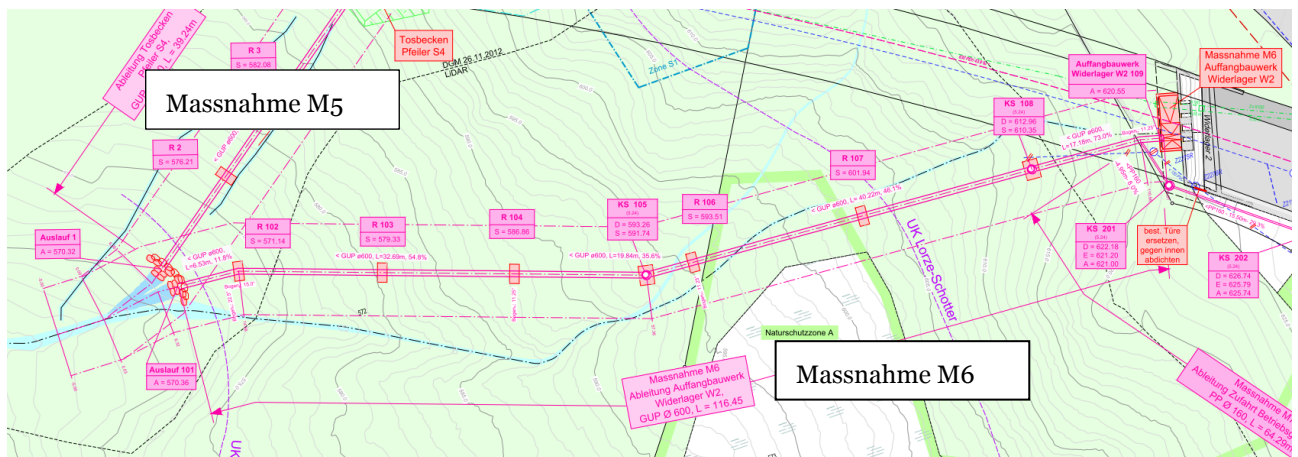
Übersicht Massnahme M6 (Grundriss)
